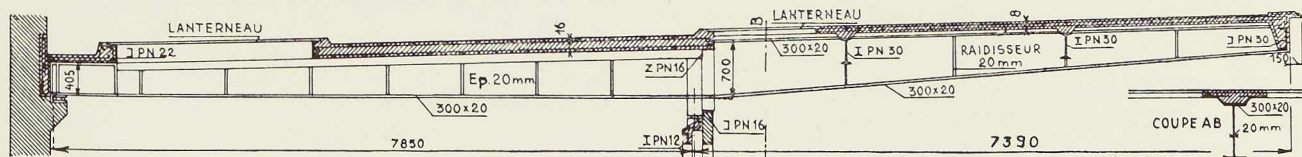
Poutre composée par soudure, supportant la toiture et présentant un porte-à-faux de 7^m39.
